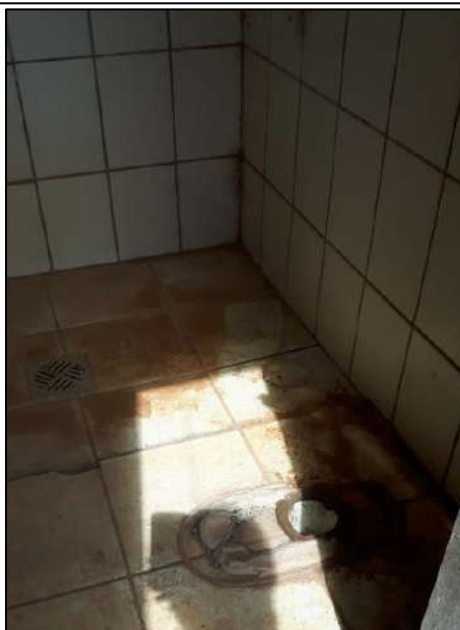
e 45 – Banheiro da oficina própria – Sem privada - Desativado há meses.
